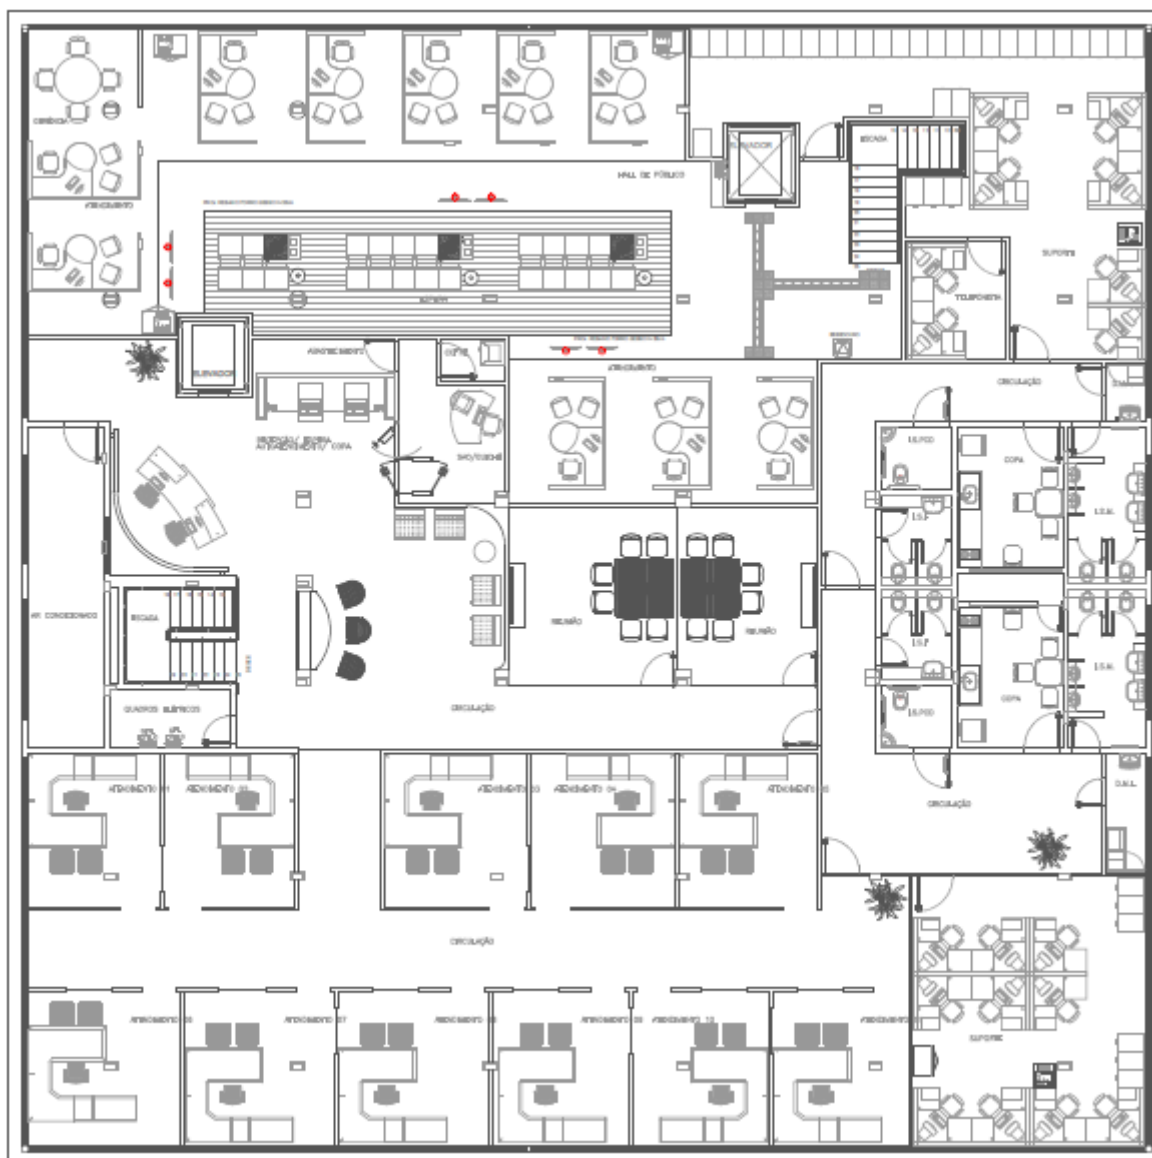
Planta baixa segundo pavimento (Banco do Brasil, 2014)
